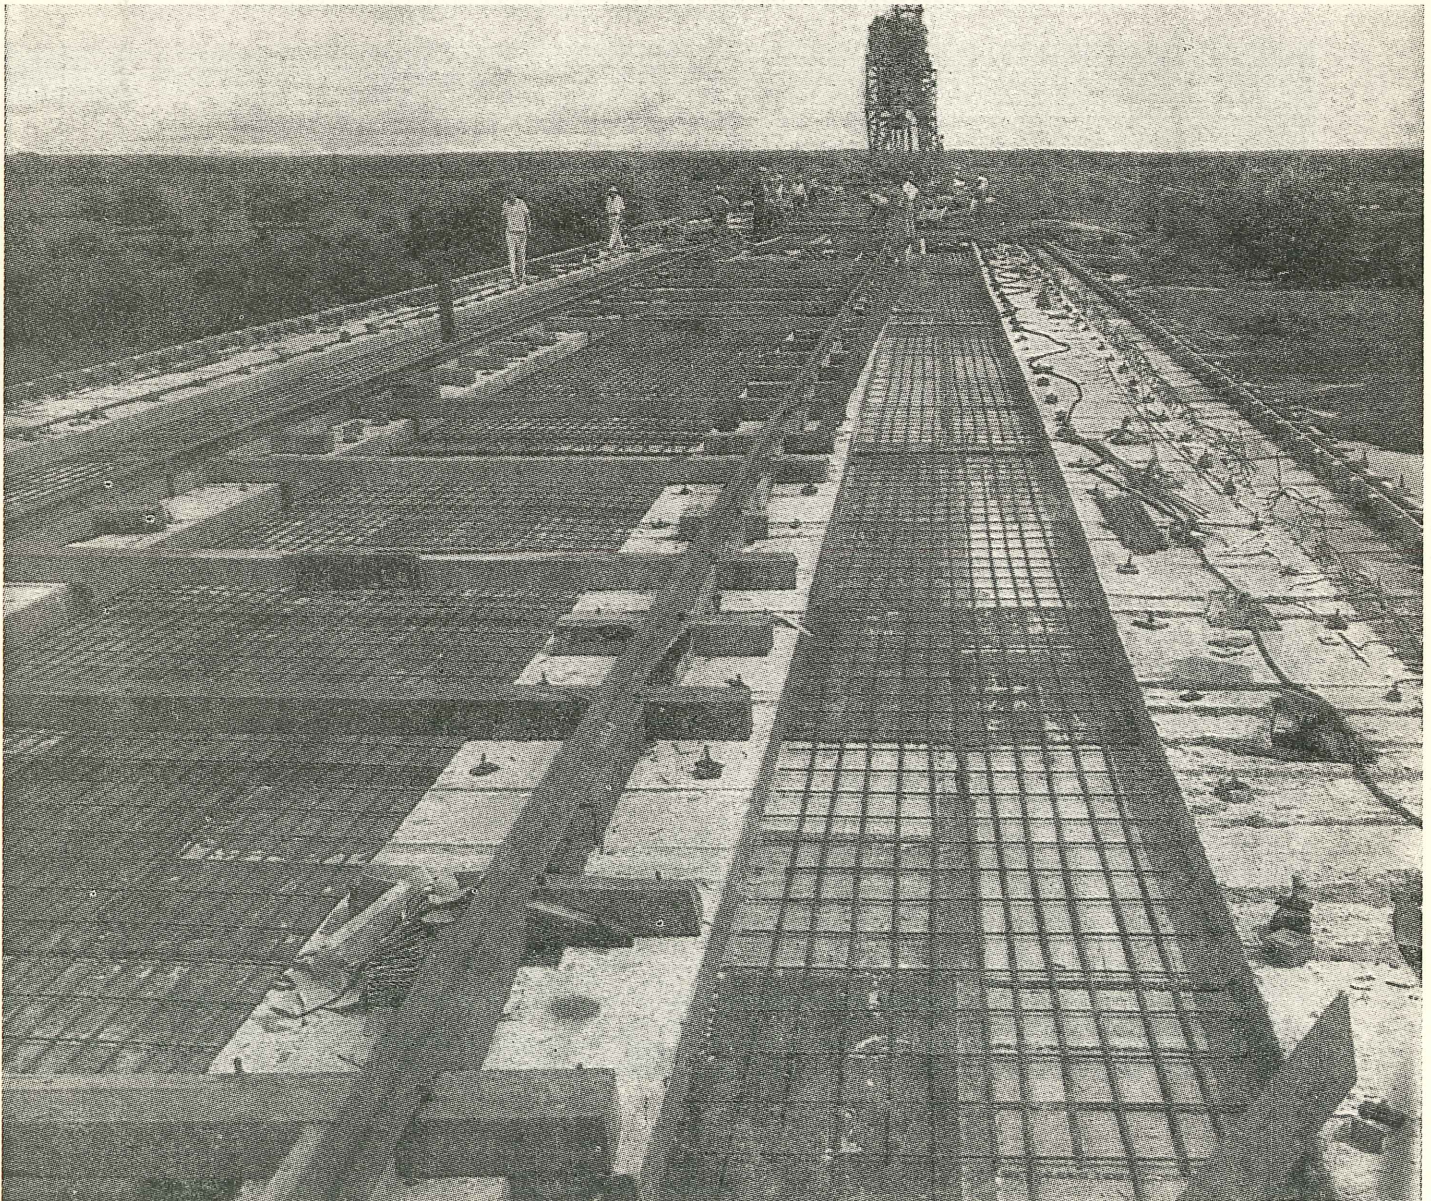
Esquema del encofrado para hormigonar las losas del tablero
